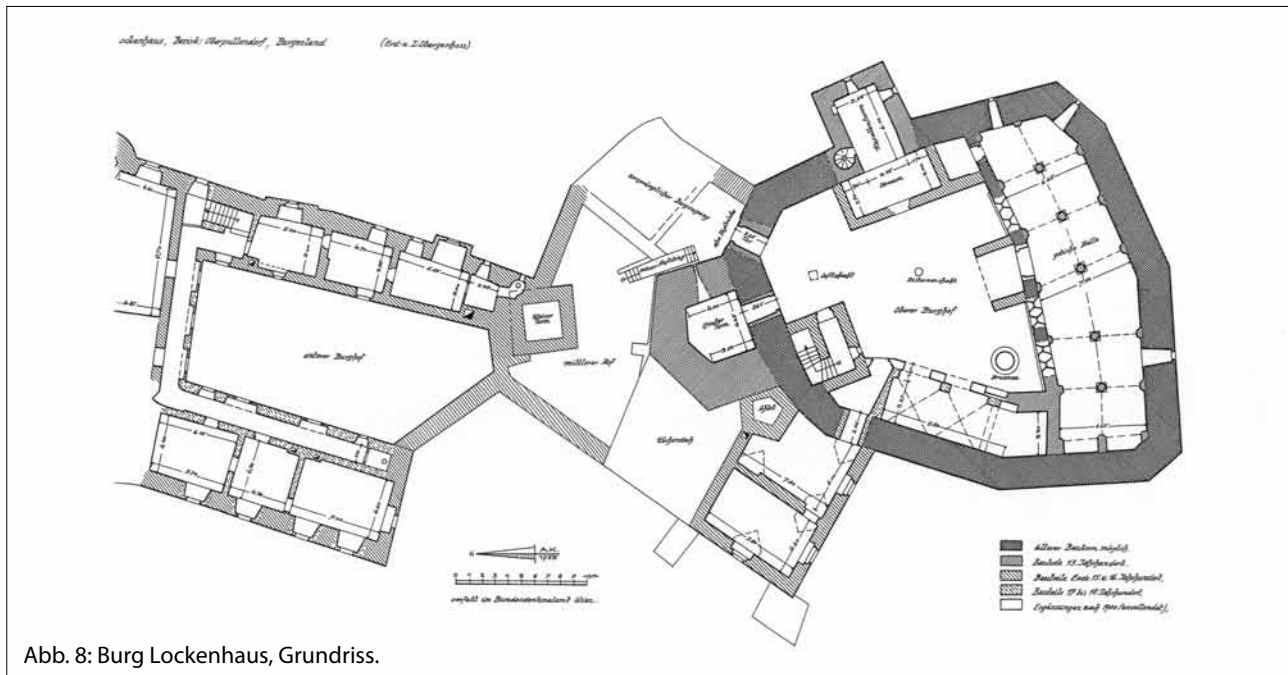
Burg Lockenhaus, Grundriss.
